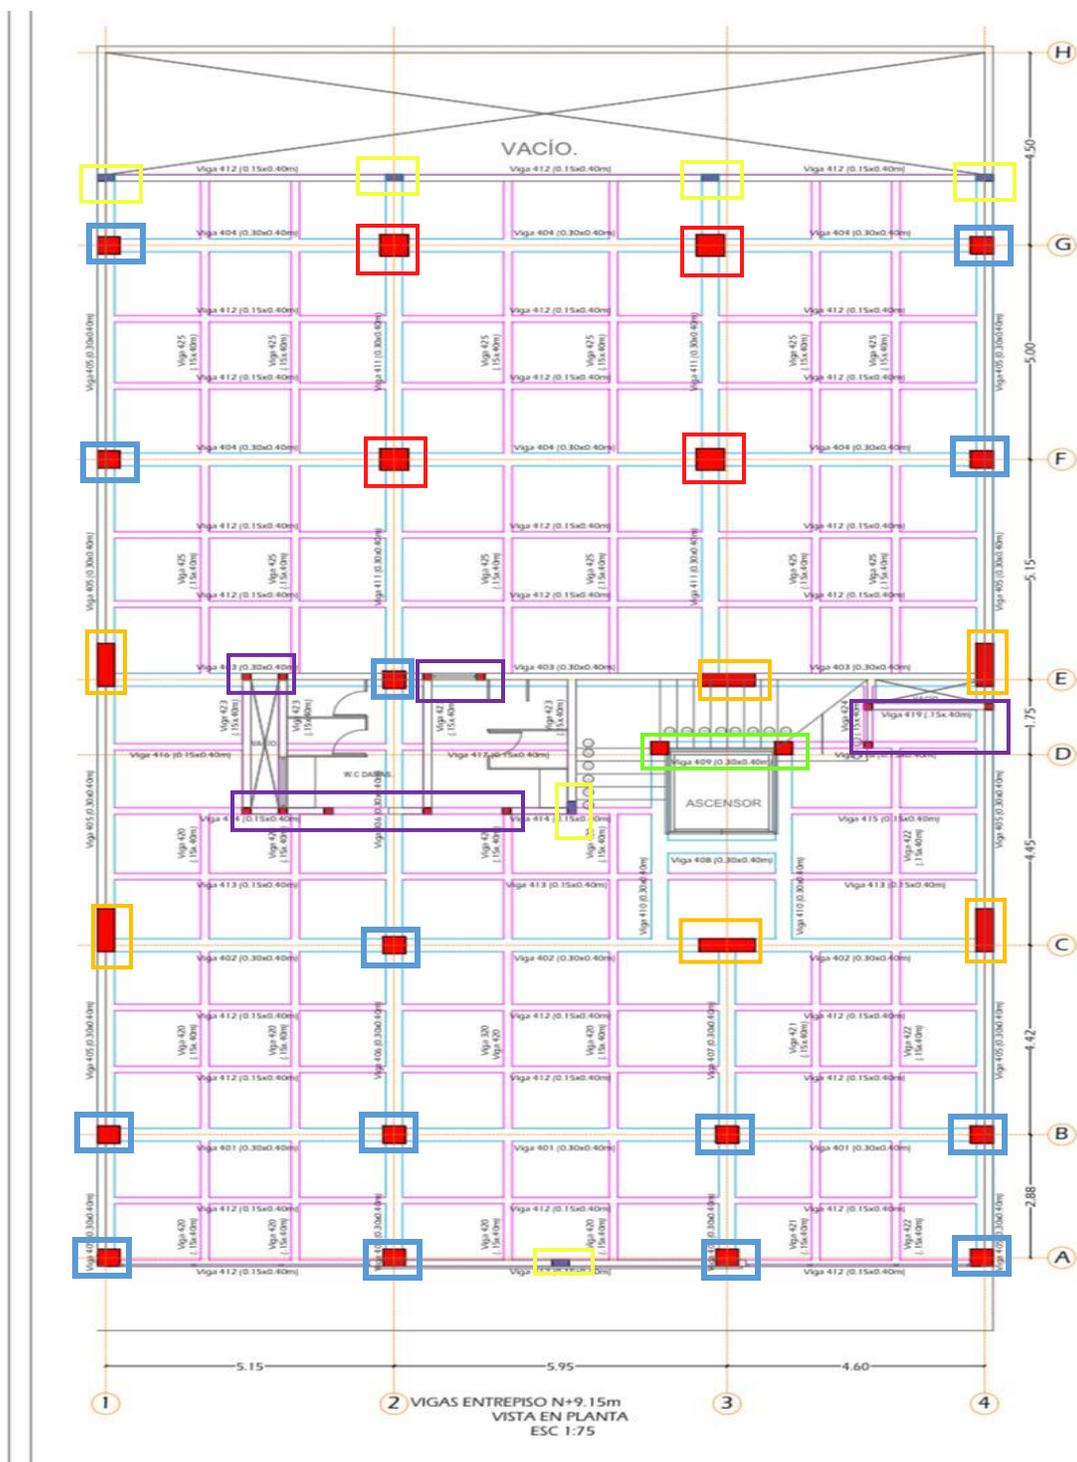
Plano vista en planta con columnas seleccionadas Edificio Wiedii
